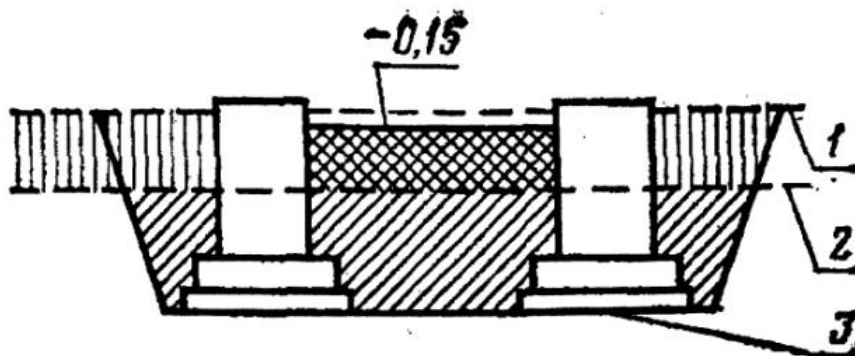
Схема разработки котлована с распределением доли грунта, относимой к различным сметам, когда на площадке предусмотрена подсыпка грунта:
